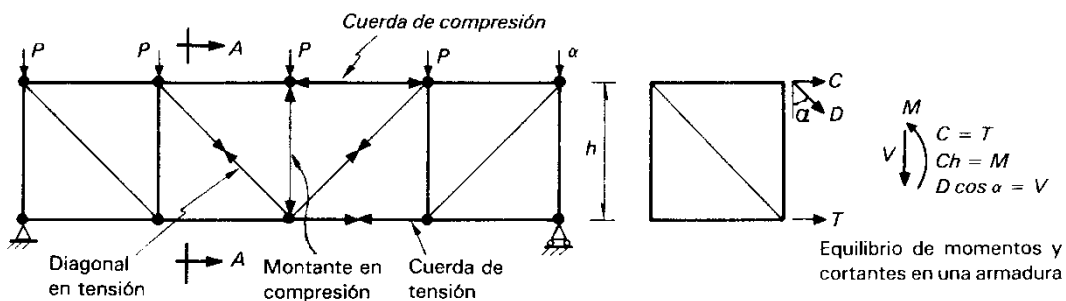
Relación de semejanza entre una armadura y una viga de alma abierta.
